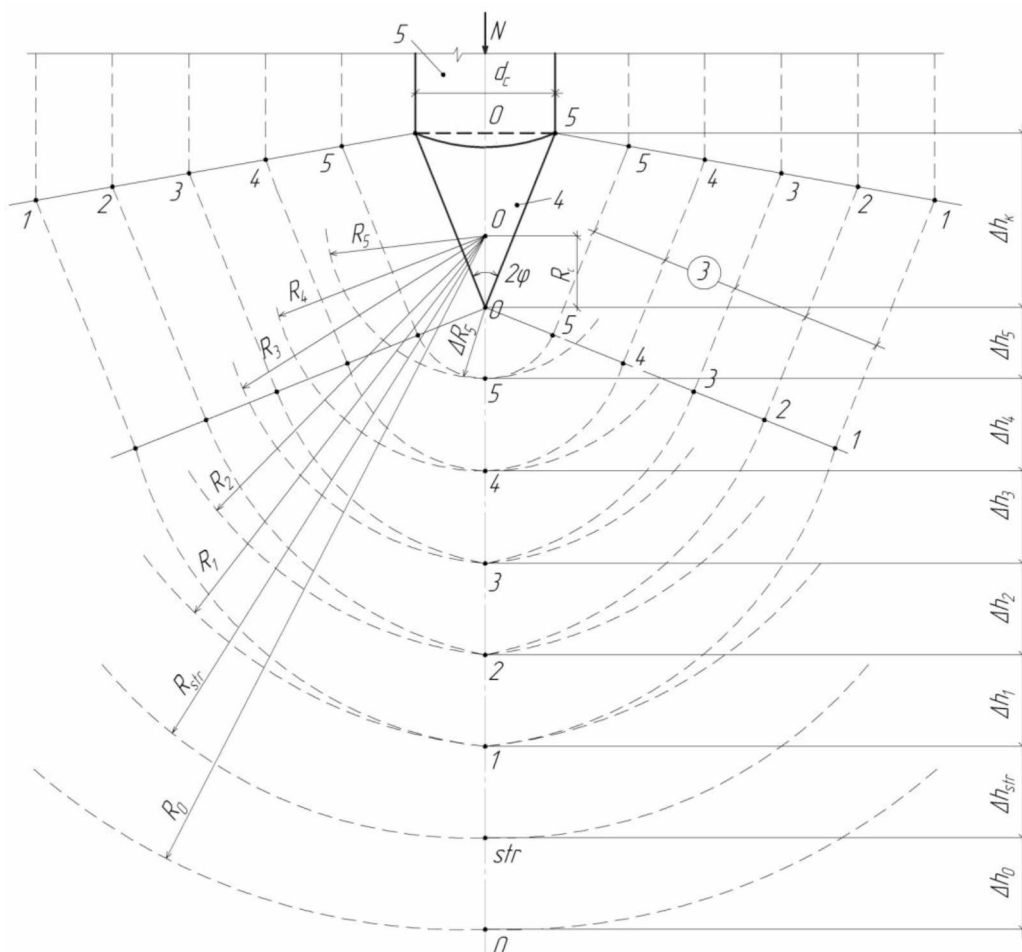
Схема развития пяти зон состояний предельных равновесий грунта в основании кругового конуса: 5 – свая; 4 – круговой конус; 3 – границы зон
